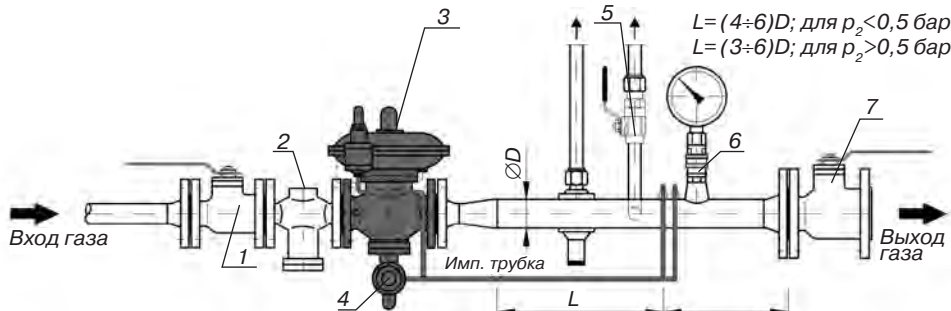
1 — запорное устройство на входе; 2 — фильтр; 3 — регулятор давления типа 139-BV; 4 — предохранительный клапан; 5 — продувочный кран; 6 — запорно-сбросной клапан для манометра; 7 — запорное устройство на выходе
